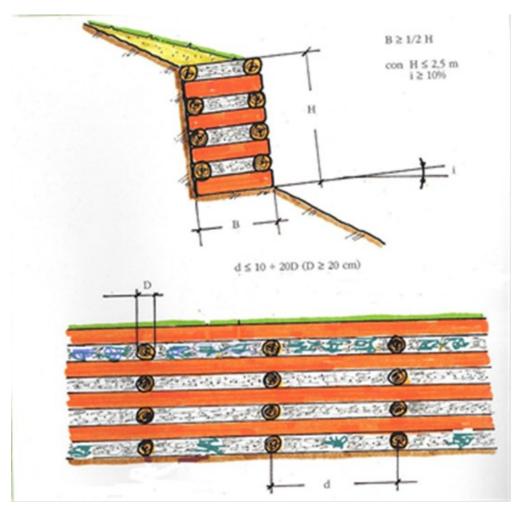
Detalle constructivo del muro con estructura de madera y piedras (Fuente: Regione Piemonte 2003).
